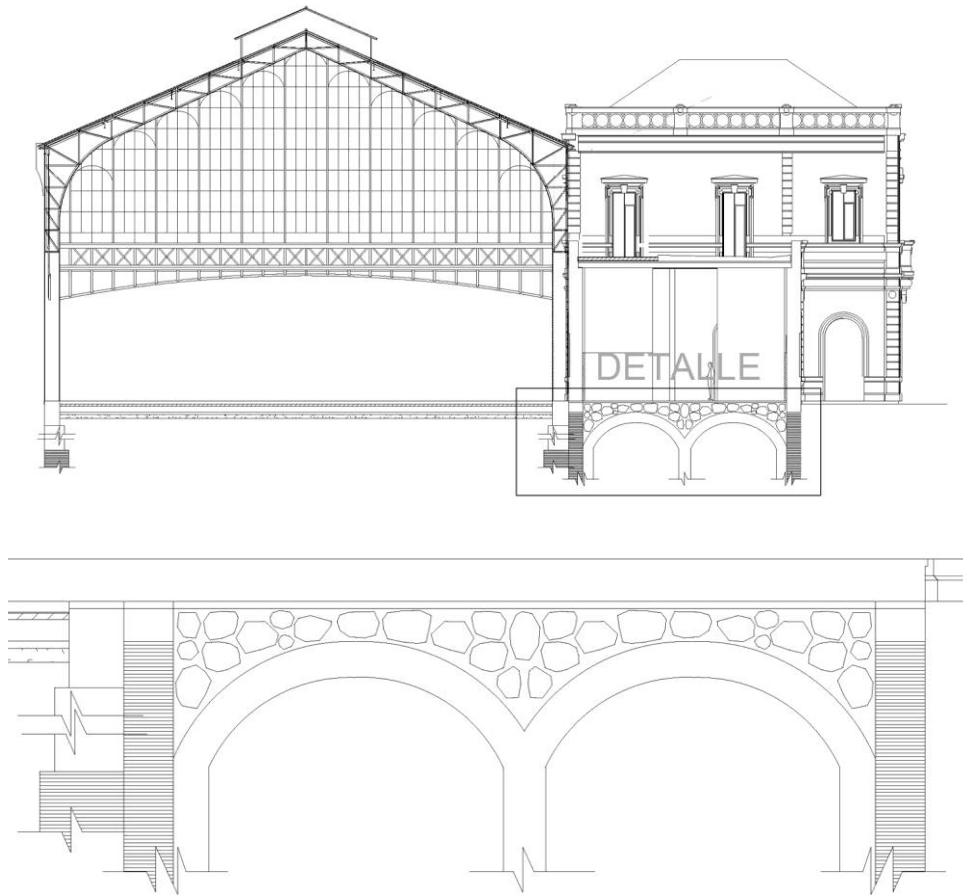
Estación de viajeros de Sevilla "San Bernardo". Detalle de la cimentación, sección Fuente; hipótesis realizada por la autora
